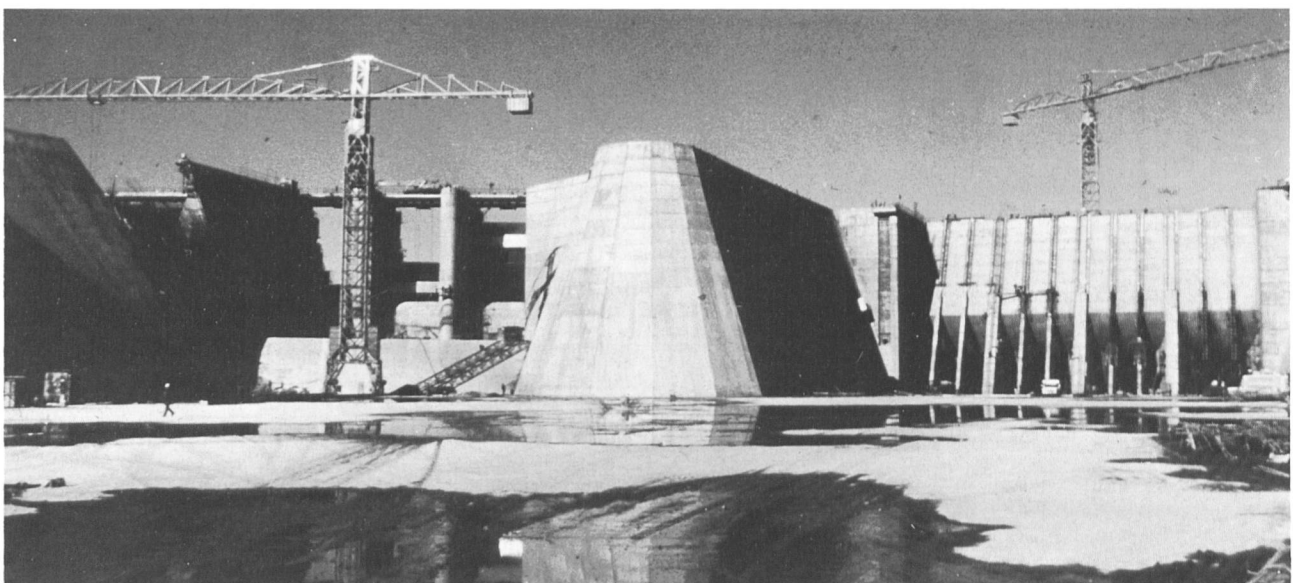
Der Einlaufkanal, ungefähr von der Dammachse her aufgenommen, mit Blick auf das Fassungsbauwerk mit 4 Öffnungen rechts und den Einlauf Hochwasserentlastung mit 3 Öffnungen links.
